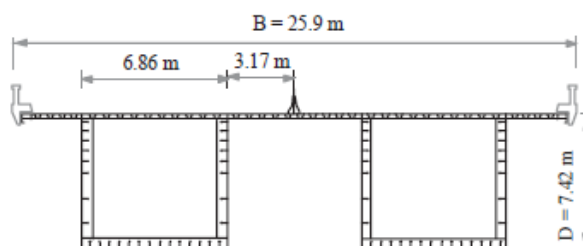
Seção transversal da ponte - corte A-A da Figura 2 – da estrutura metálica da ponte Rio-Niterói (Battista e Pfeil, 2000).
